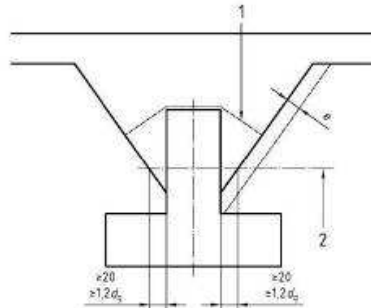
Definición de los niveles de verificación para viguetas de hormigón armado y pretensado
